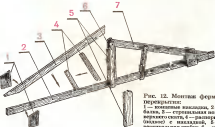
Монтаж фермы перекрытия: 1 — вертикальная опора, 2 — балка, 3 — стропильная нога верхнего ската, 4 — раскоска (шпилька) с накладкой, 5 — вертикальная стойка, 6 — накладка, 7 — крыло фермы в сборе.
